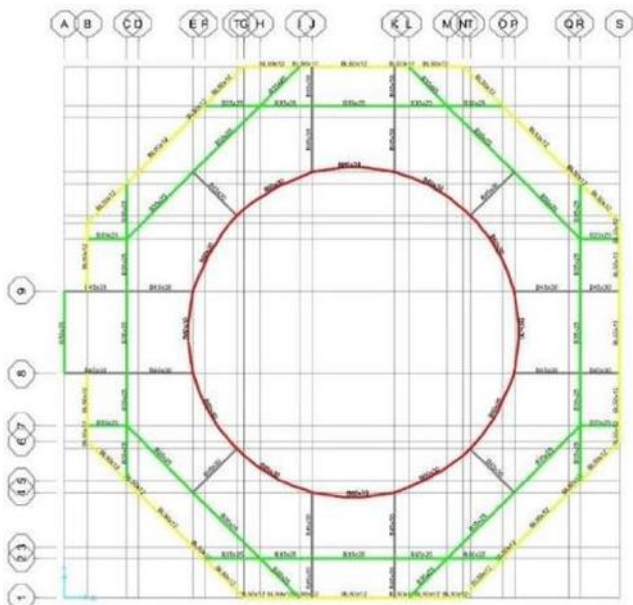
Penggambaran Struktur Bangunan Masjid pada Aplikasi SAP2000
